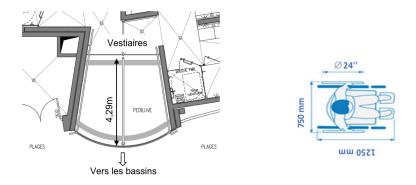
Dimensions pédiluve et gabarit fauteuil roulant
